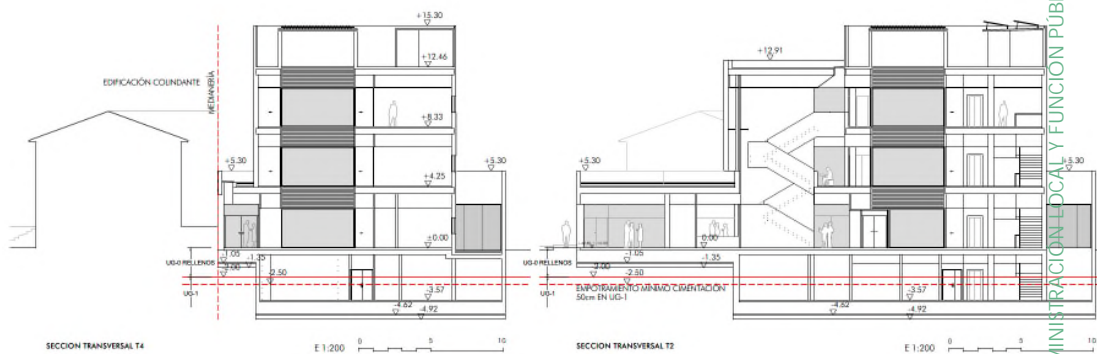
Detalle de dos secciones transversales, donde se observa la distribución en planta baja donde no presenta sótano y cuatro alturas donde se tiene prevista la ejecución de sótano.
